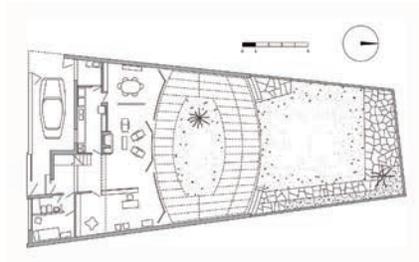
Planta baja del proyecto para la casa Tedeschi (fuente: Elaboración propia, 2011).
